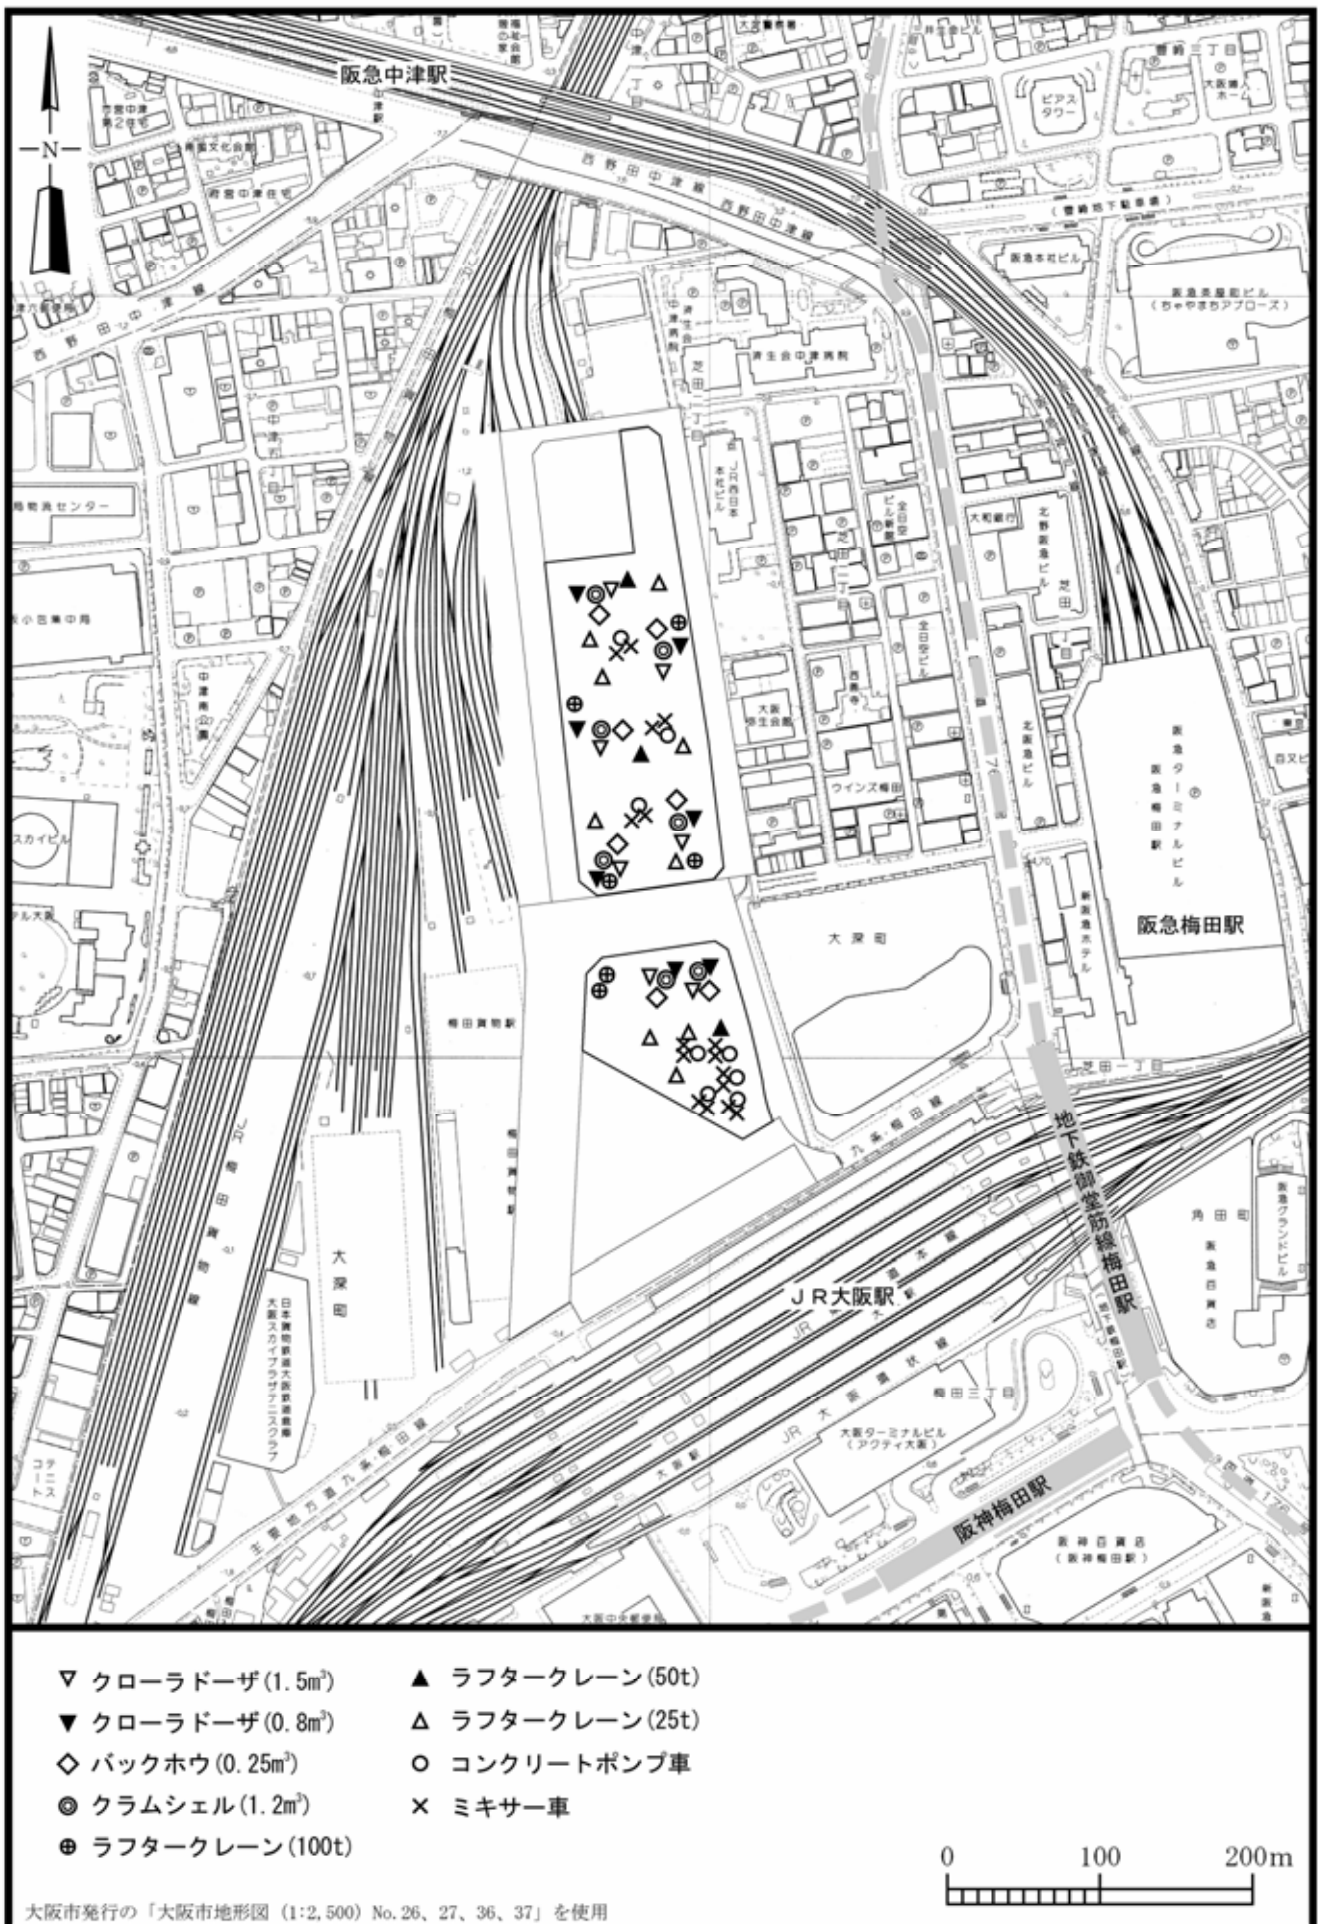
(3) 騒音源配置図 (全体工事最盛期)
